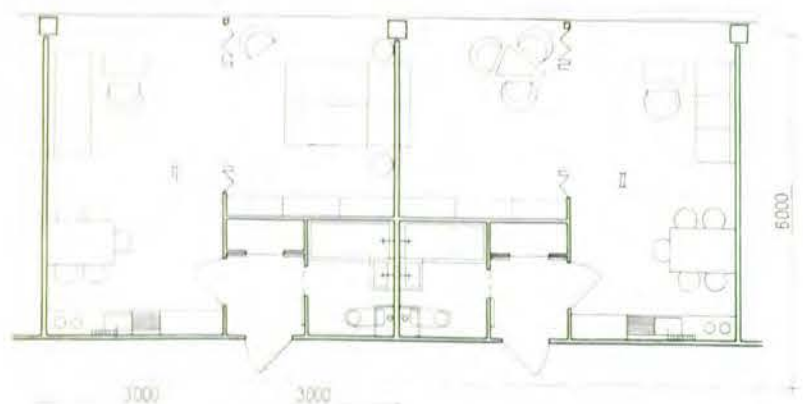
Grundrisse einer Ein-, Zwei- und Dreiraumwohnung bei einer Wohnflächennorm von 12 m²/Person
